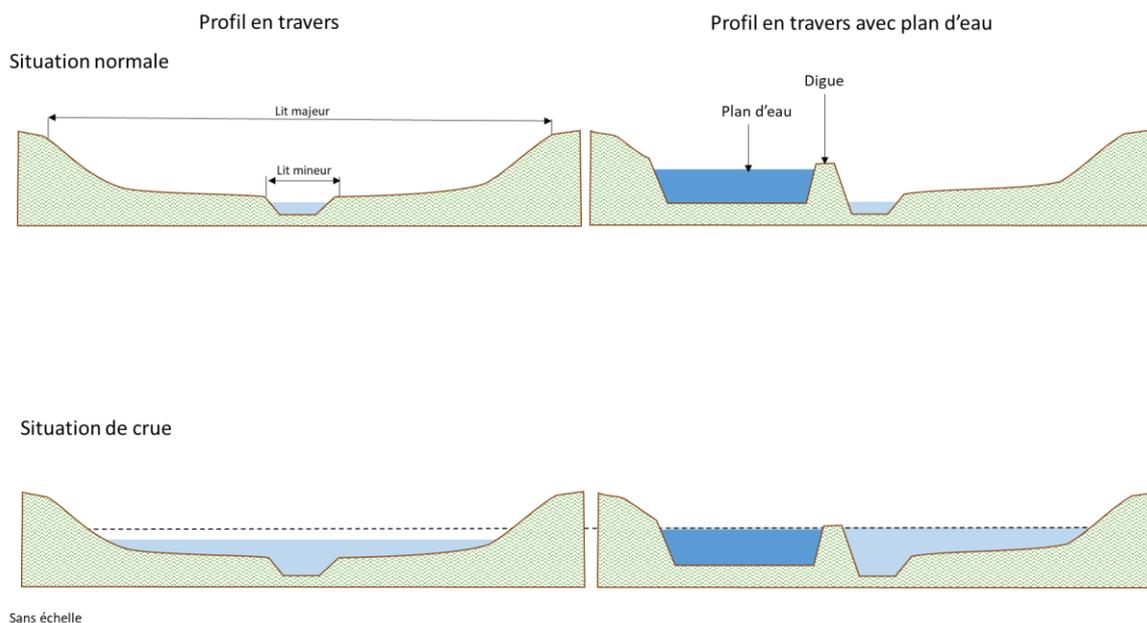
Schéma illustratif de l'impact de plans d'eau en remblai sur le débordement du lit mineur
